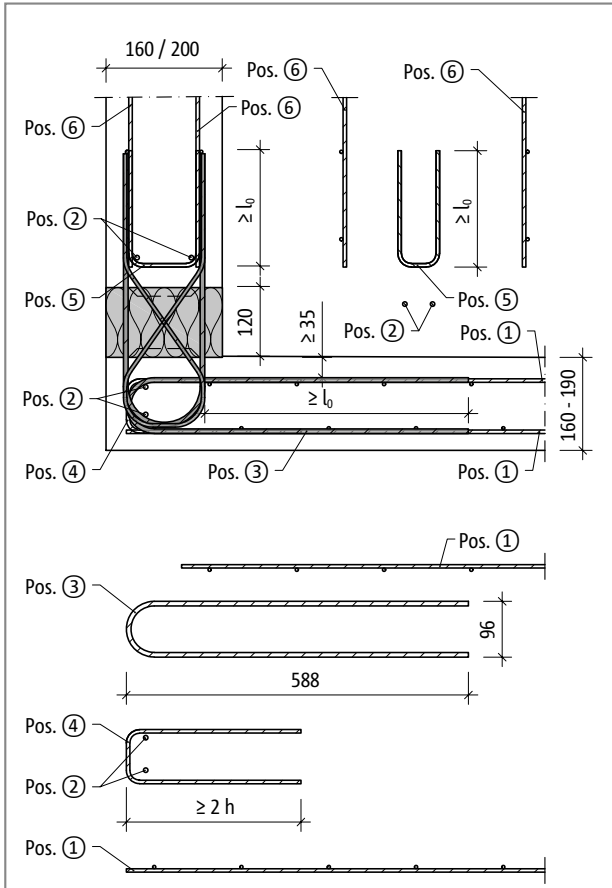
Schöck Isokorb® XT Typ A: Bauseitige Bewehrung innenliegend (B = 160 und B = 200)
